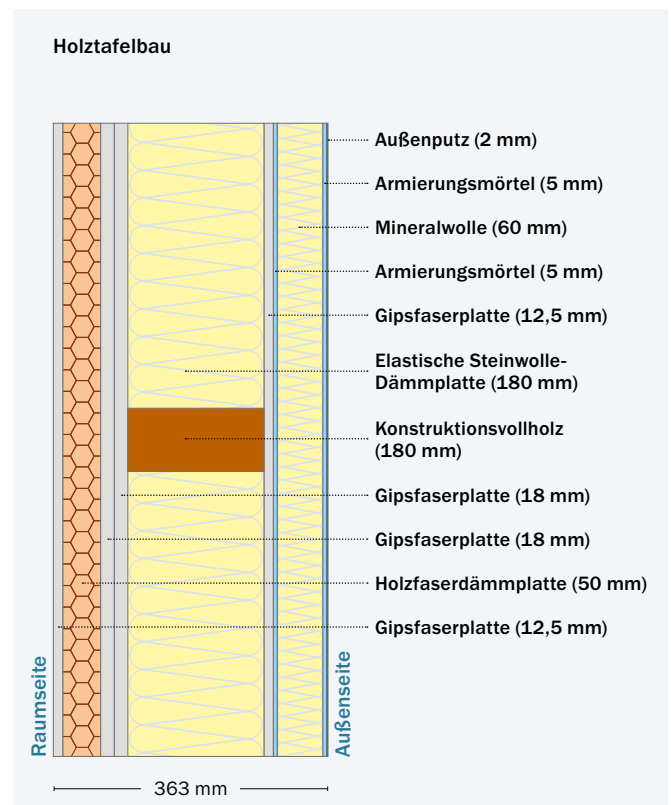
Aufbau der Holztafelbau-Außenwand im Mehrfamilienhaus in Holzbauweise
